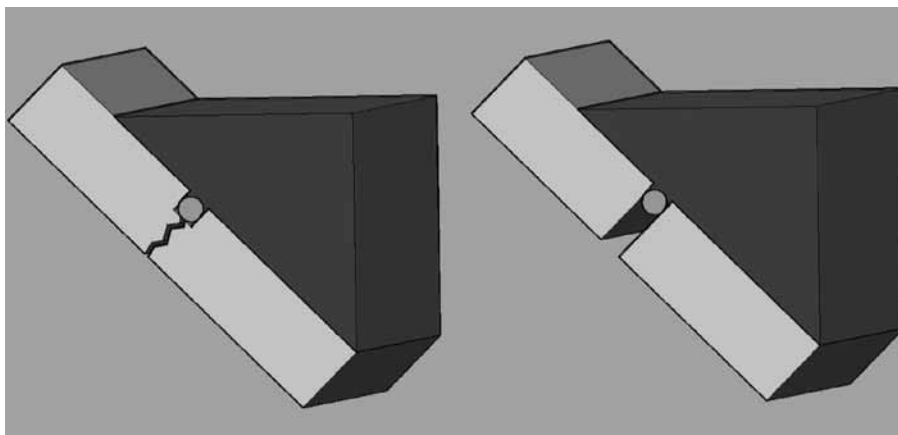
Juntas de retracção (esq) e de trabalho (dir)
